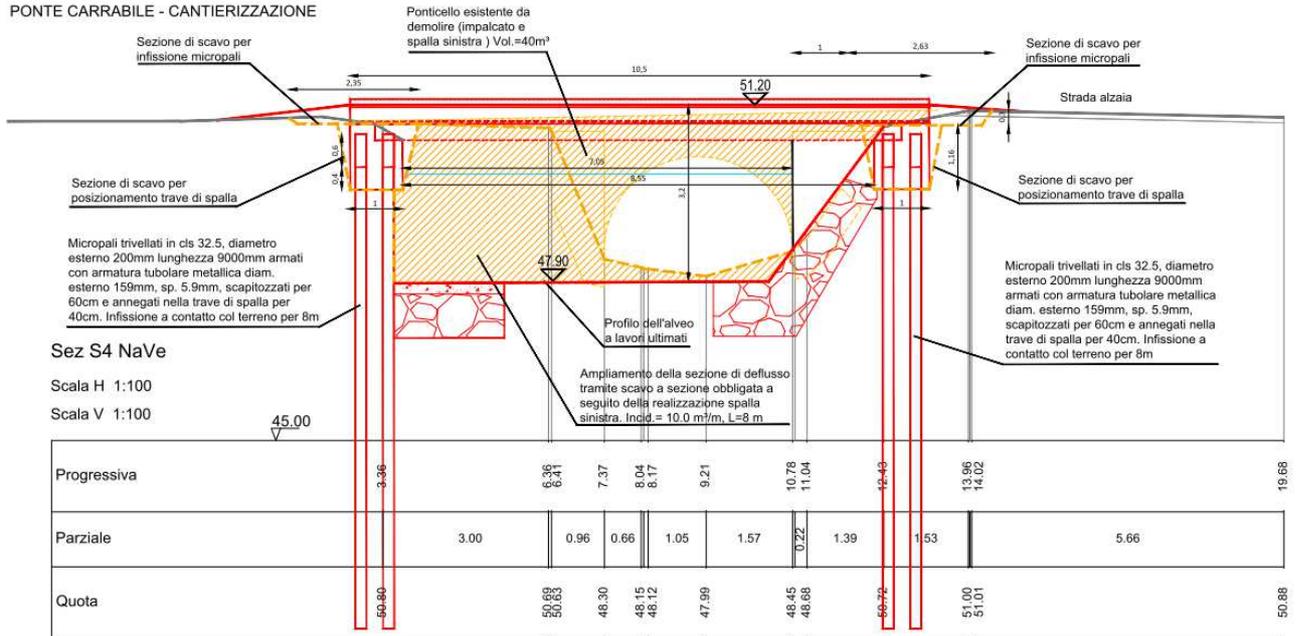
SEZIONE DI CANTIERIZZAZIONE DEL NUOVO PONTE CARRABILE SUL CANALE QUISTRA.
